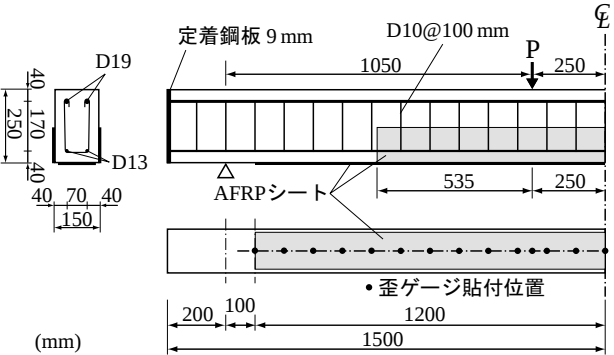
試験体の形状寸法、配筋状況、載荷点位置およびシート補強概要図の一例 (S125-vh 試験体)
